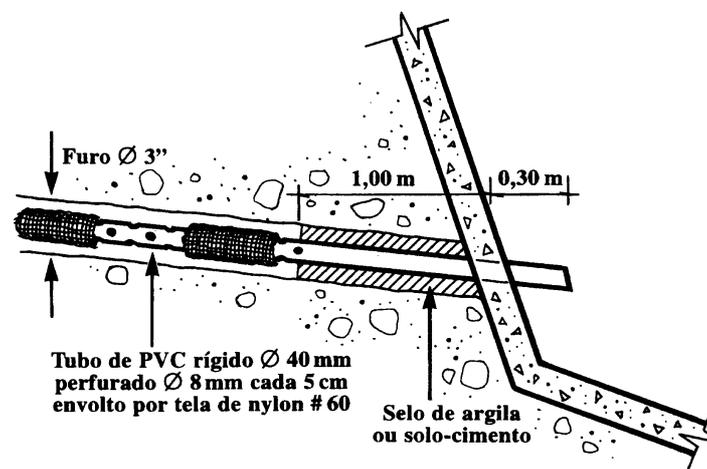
Detalhe do dreno subhorizontal profundo (Hachich e outros,1998).
